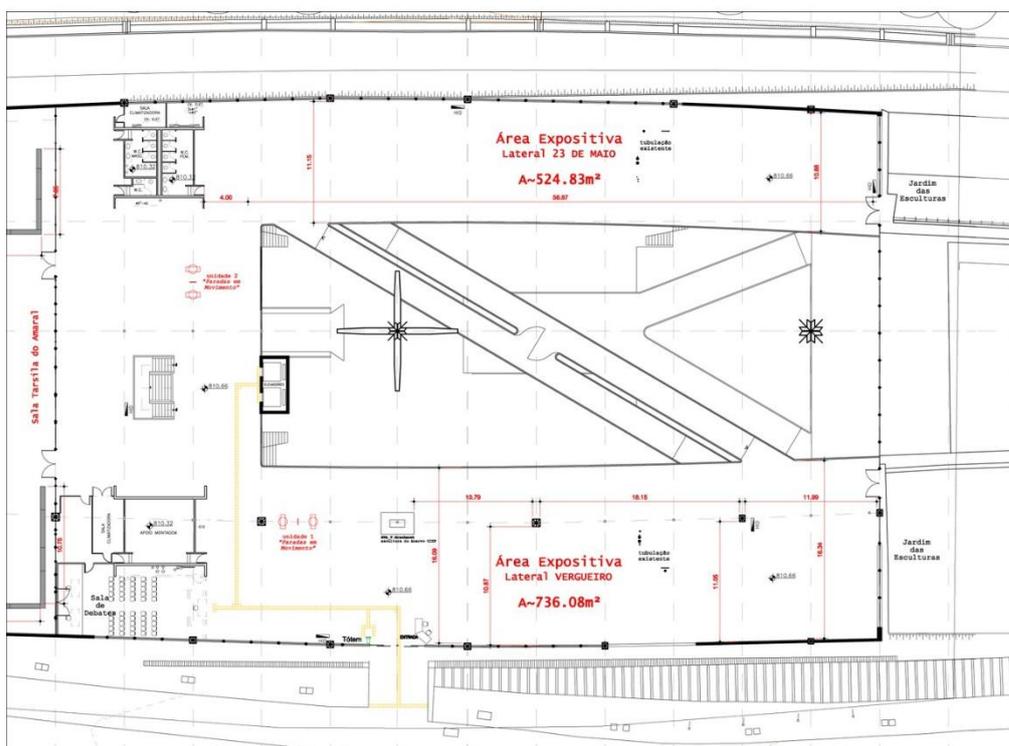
11 Planta Baixa do Pavimento Caio Graco / Cota 810
